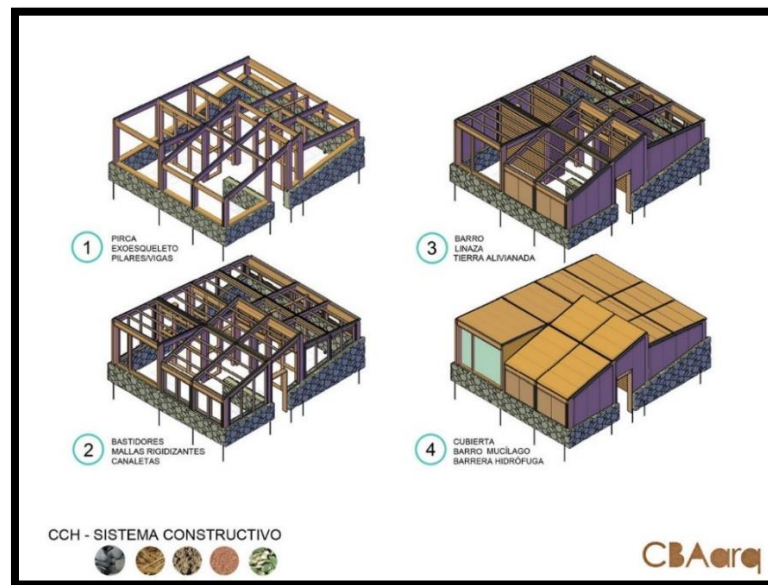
materiales que se usan en la construcción de la cubierta y estructura del módulo.
